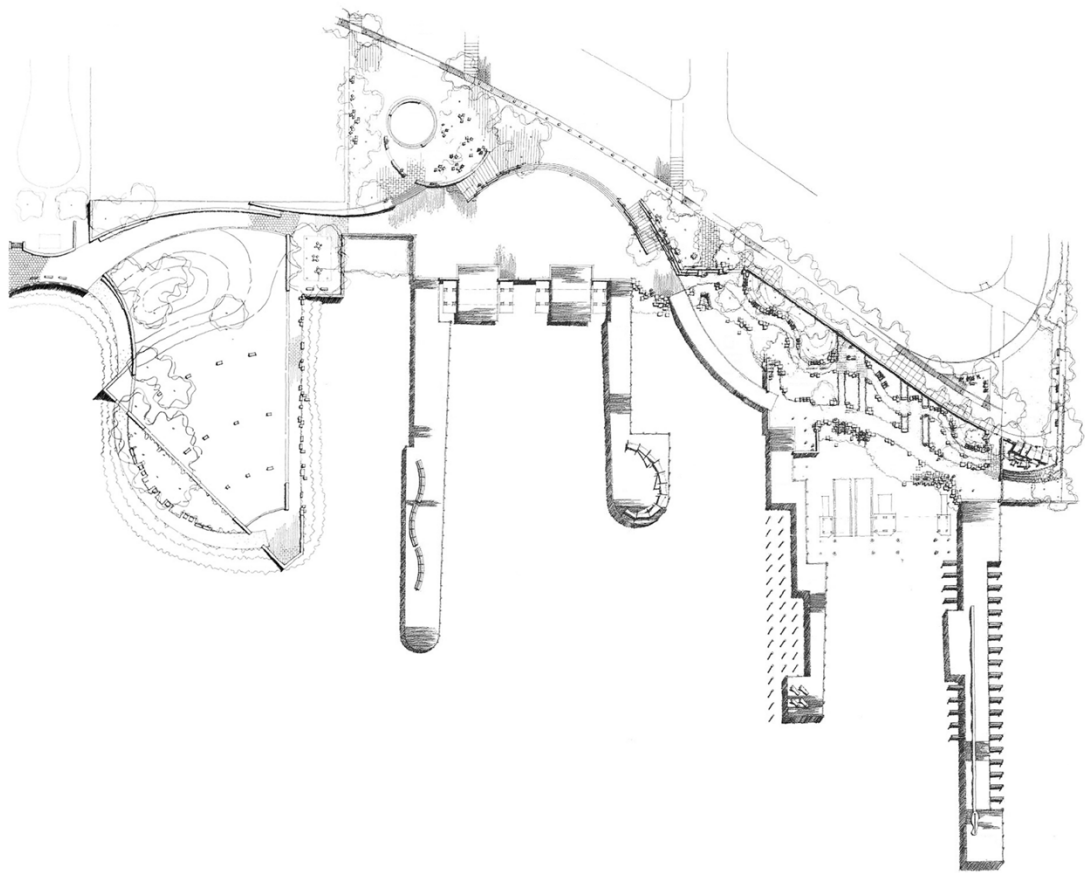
Thomas Balsley, boceto para la propuesta en planta de Gantry Plaza State Park, 1998.
